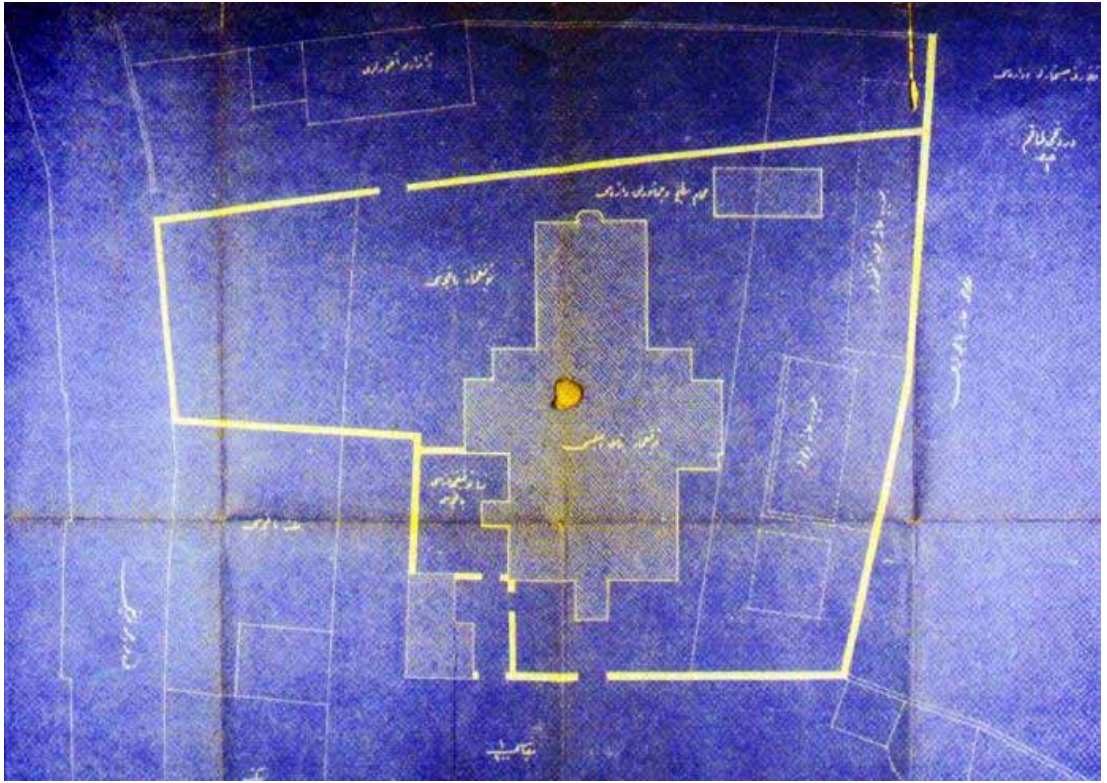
Paşakapısı Cezaevi Vaziyet Planı
